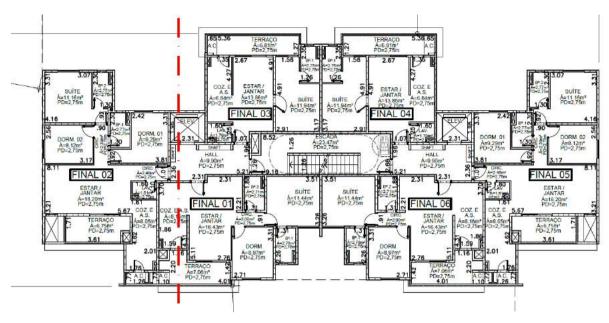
Projeto - Pavimento Tipo - Torres 1 e 2.
